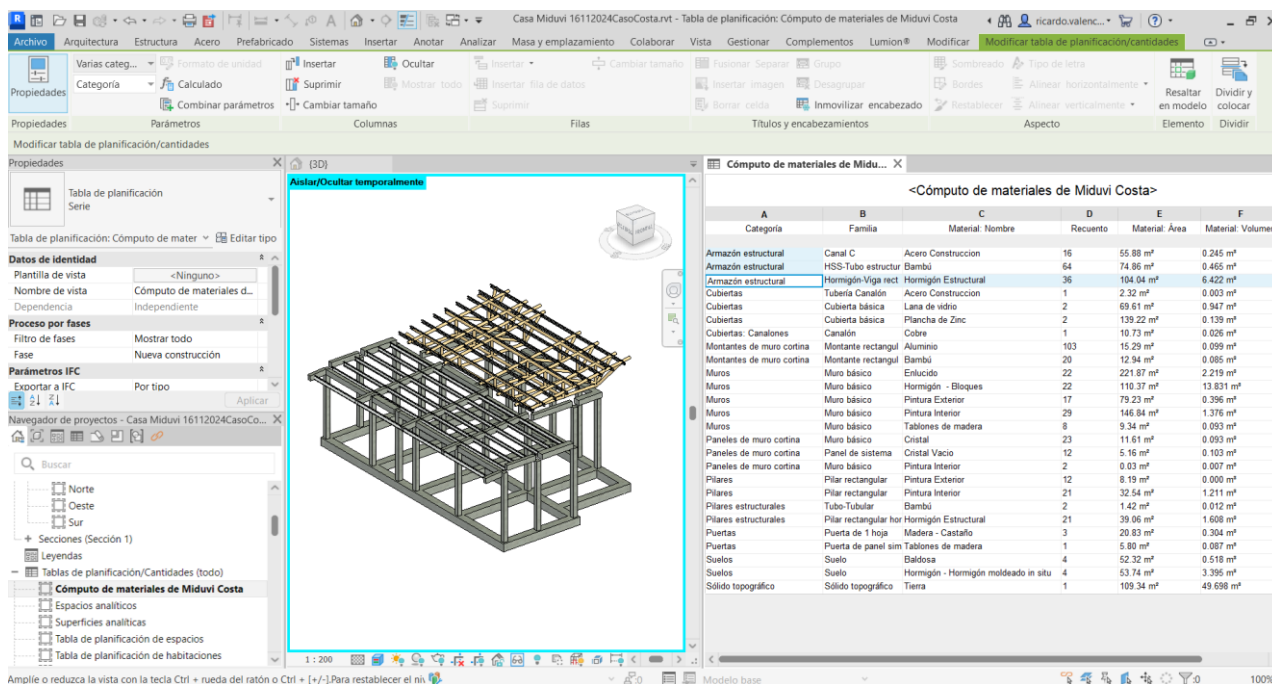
Estructura y modelado de Cubierta, soporte bambú. Fuente: Elaboración Propia.
